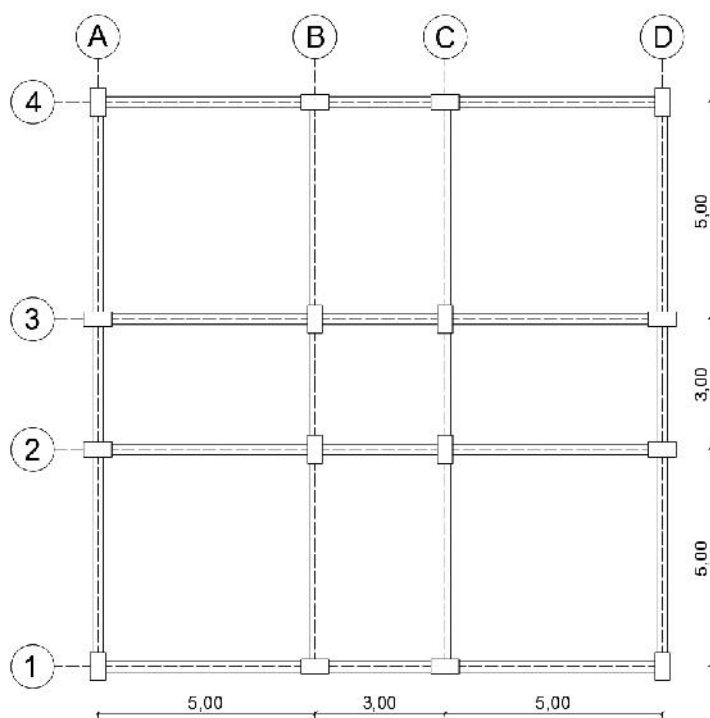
Planta indicativa da geometria dos elementos estruturais
